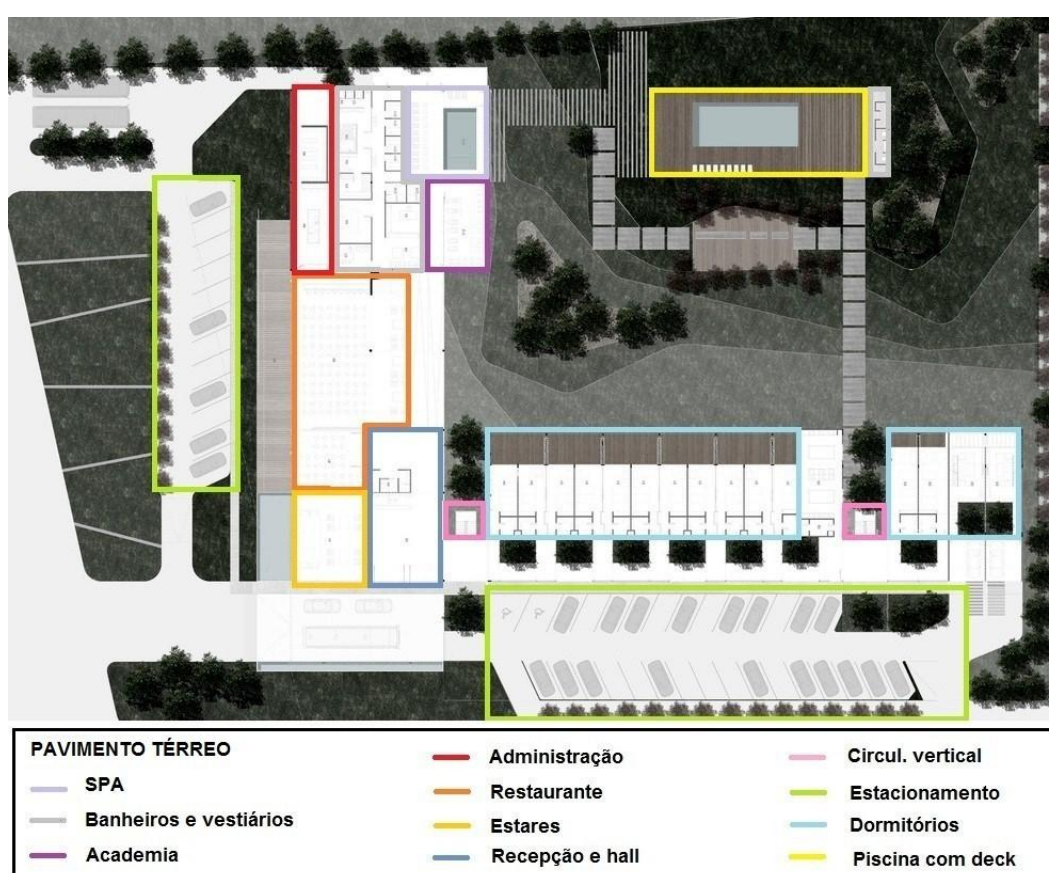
Planta baixa do pavimento térreo do Hotel.
